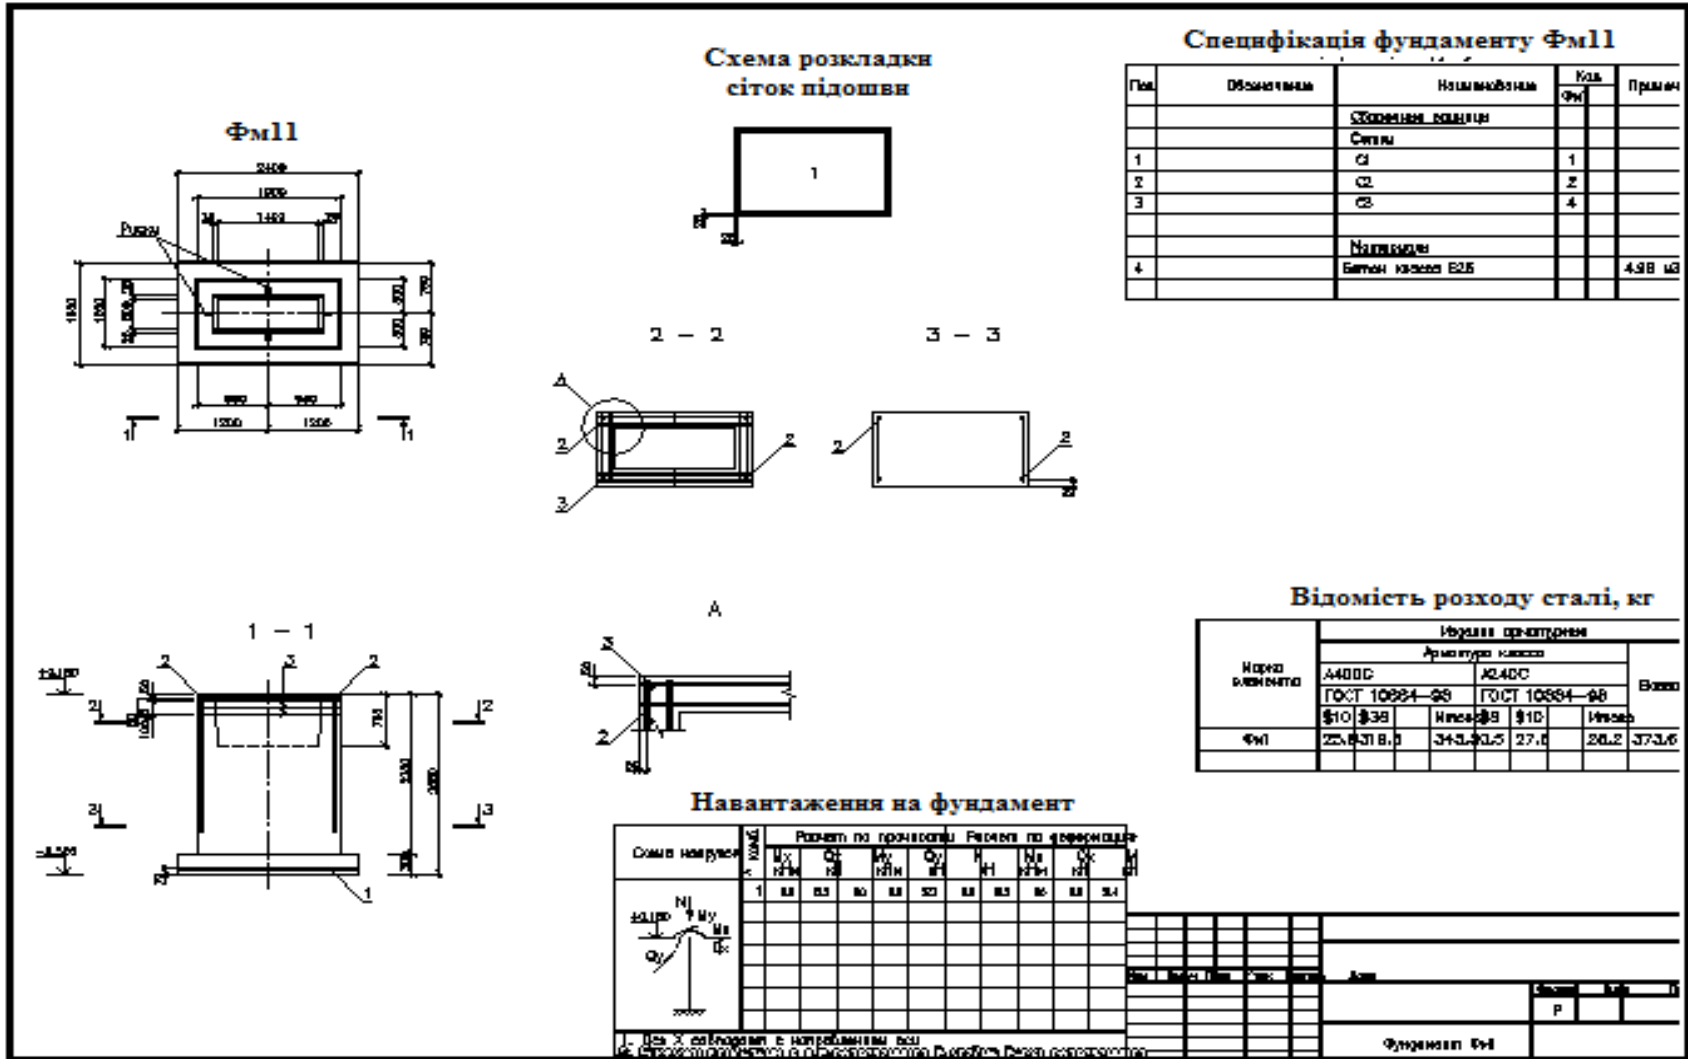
Фундамент Фм1. Опалубкове креслення робочого проекту
